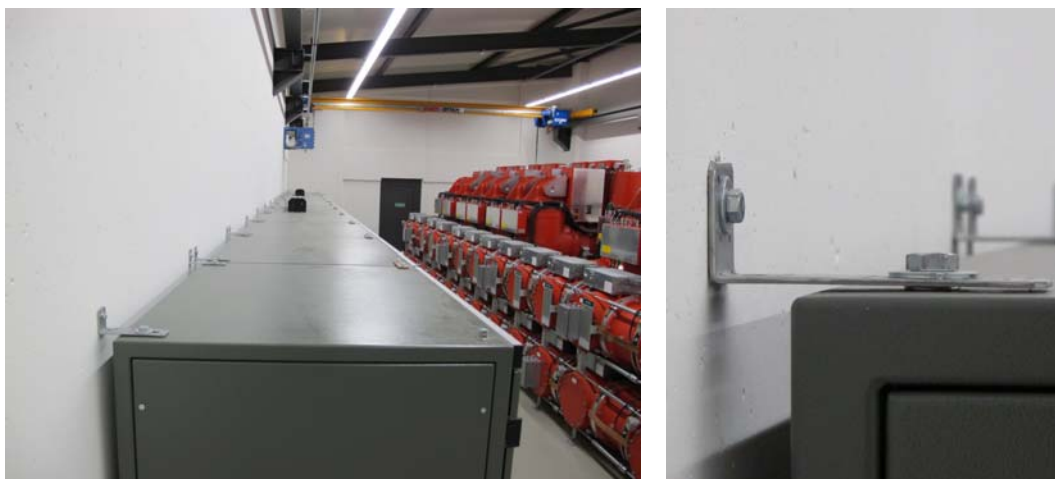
/E.4: Armadi di comando fissati alla parete attraverso barre di metallo ad angolo (axpo AG)
